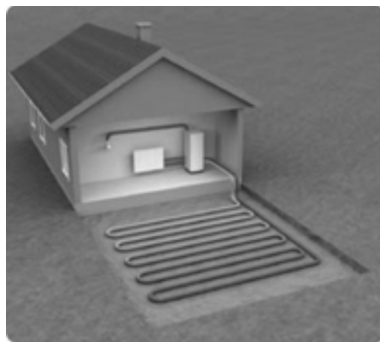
Тепловой насос для отопления жилого дома с использованием грунтового тепла.
